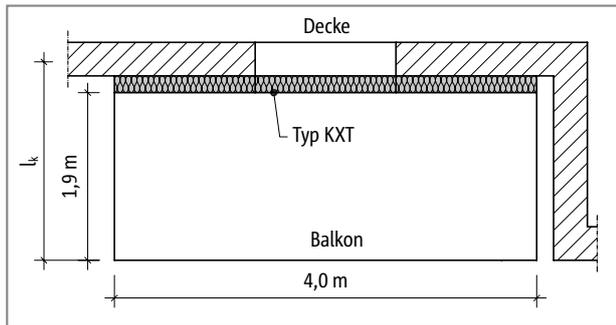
Schöck Isokorb® Typ KXT: Grundriss
